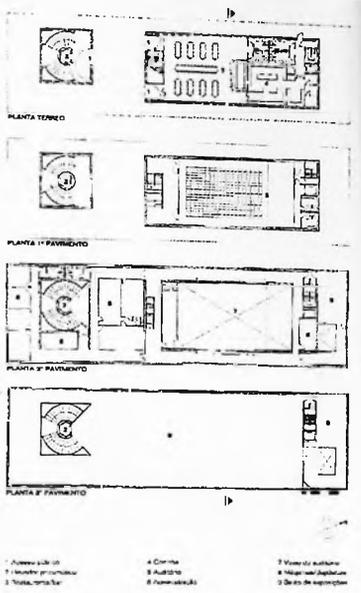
Pavilhão de Sevilha, 1991, plantas
